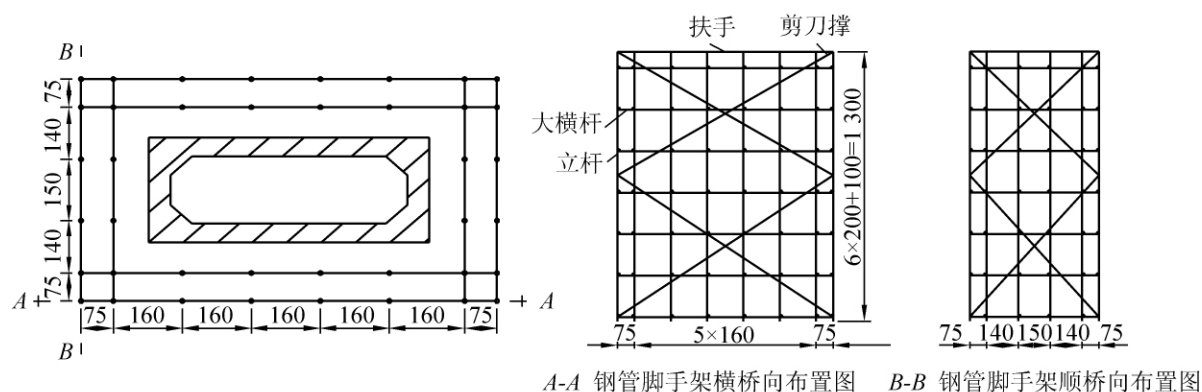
钢管双排架脚手架平面布置示意图(单位: cm)
